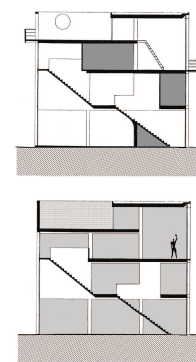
Au dessus, les espaces annexes qui occupent le vide de la lame des escaliers et altèrent la continuité verticale de l'espace. En bas, l'ossature des poteaux et des poutres qui sépare les deux travées et en règle les échanges.
